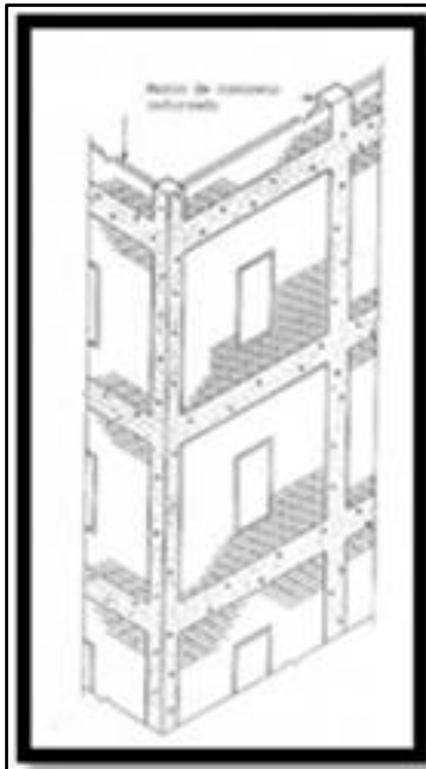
Relleno de mamposterías no reforzada de corte de concreto
